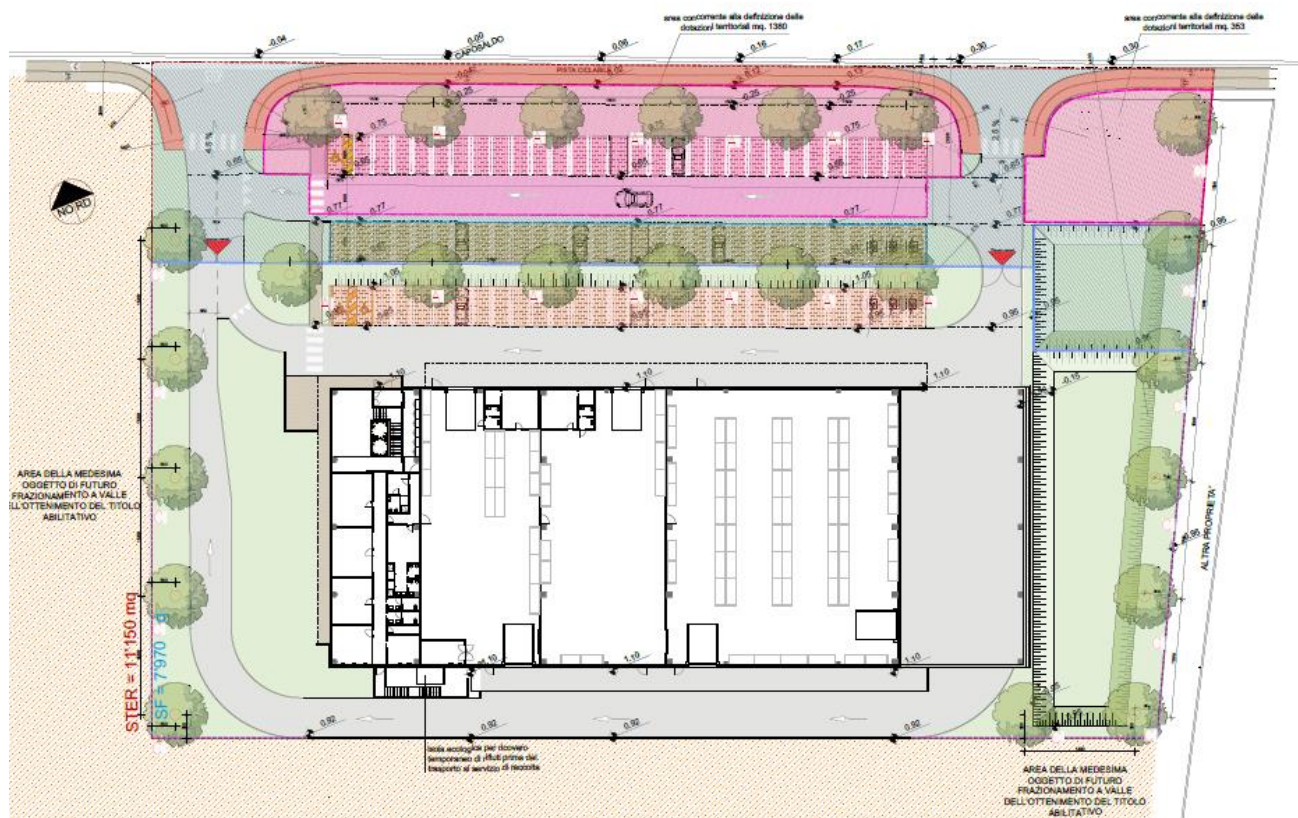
Planimetria generale di progetto, con indicazione delle essenze arboree previste
